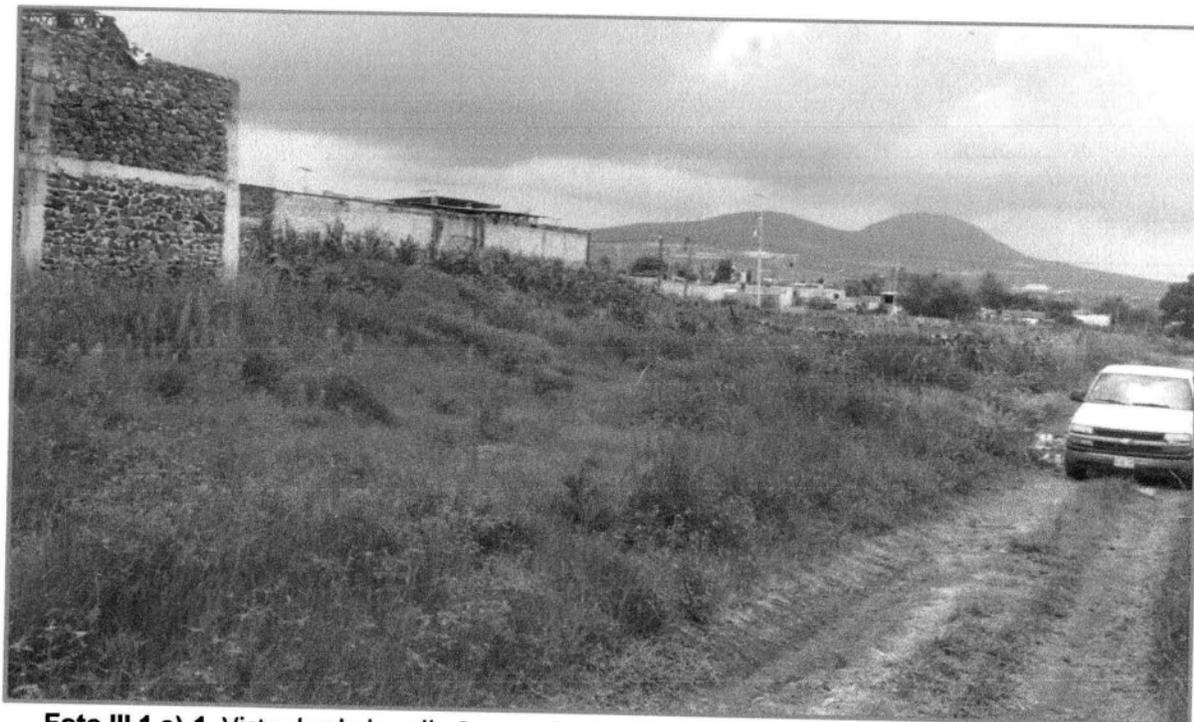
a)-1. Vista desde la calle Saucos, hacia el interior del predio y su colindancia oeste.
